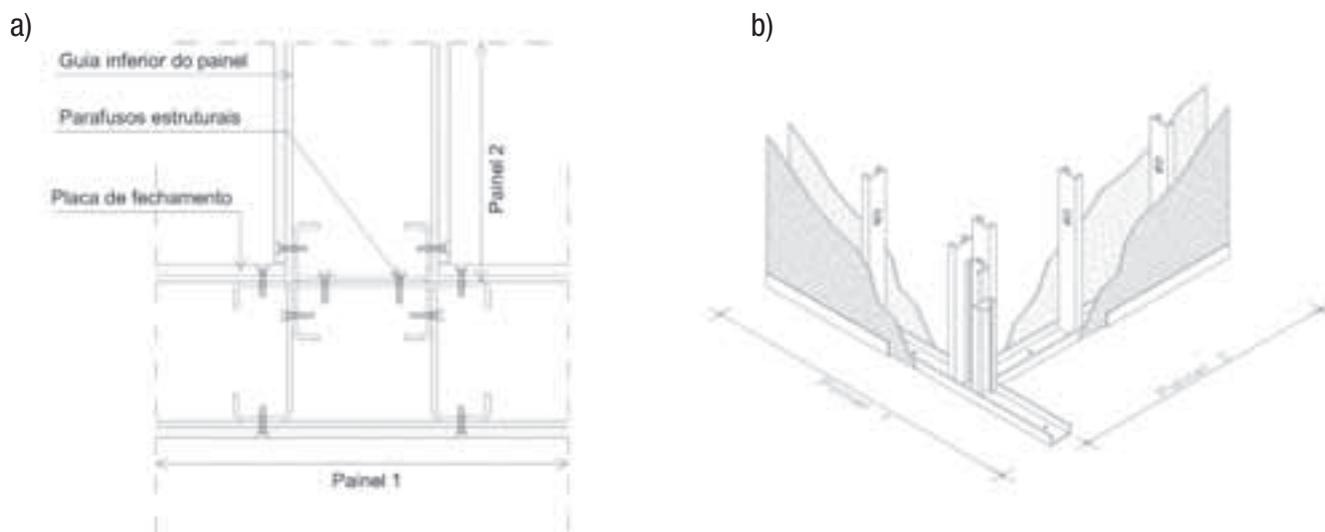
Ligação de dois painéis formando um “T”: a) planta b) perspectiva
